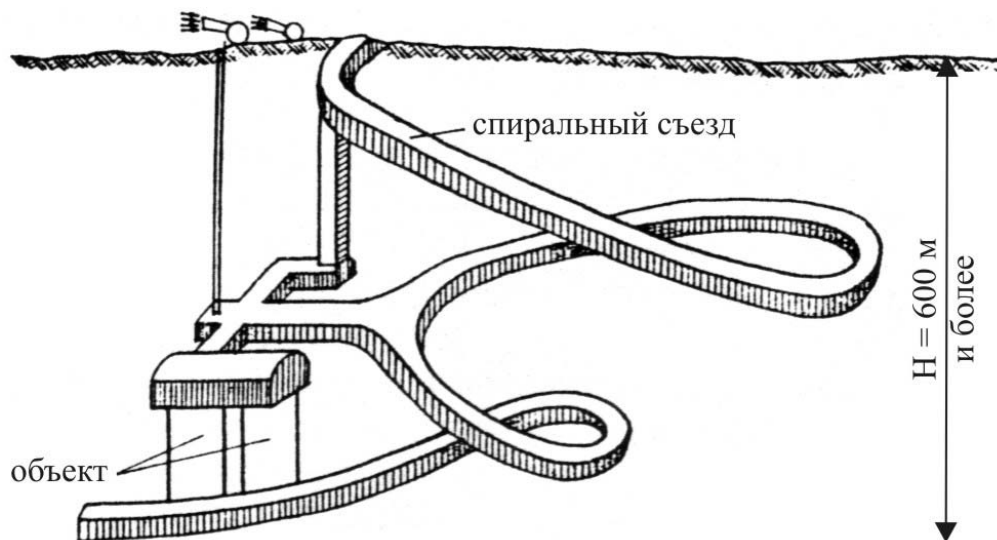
Спиральный съезд, вертикальный вентиляционный ствол, вентиляционная скважина
